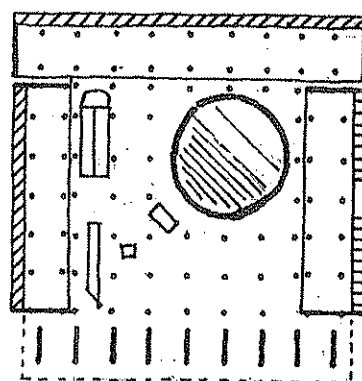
Planta de la Asamblea de Chandigarh – L.C.
